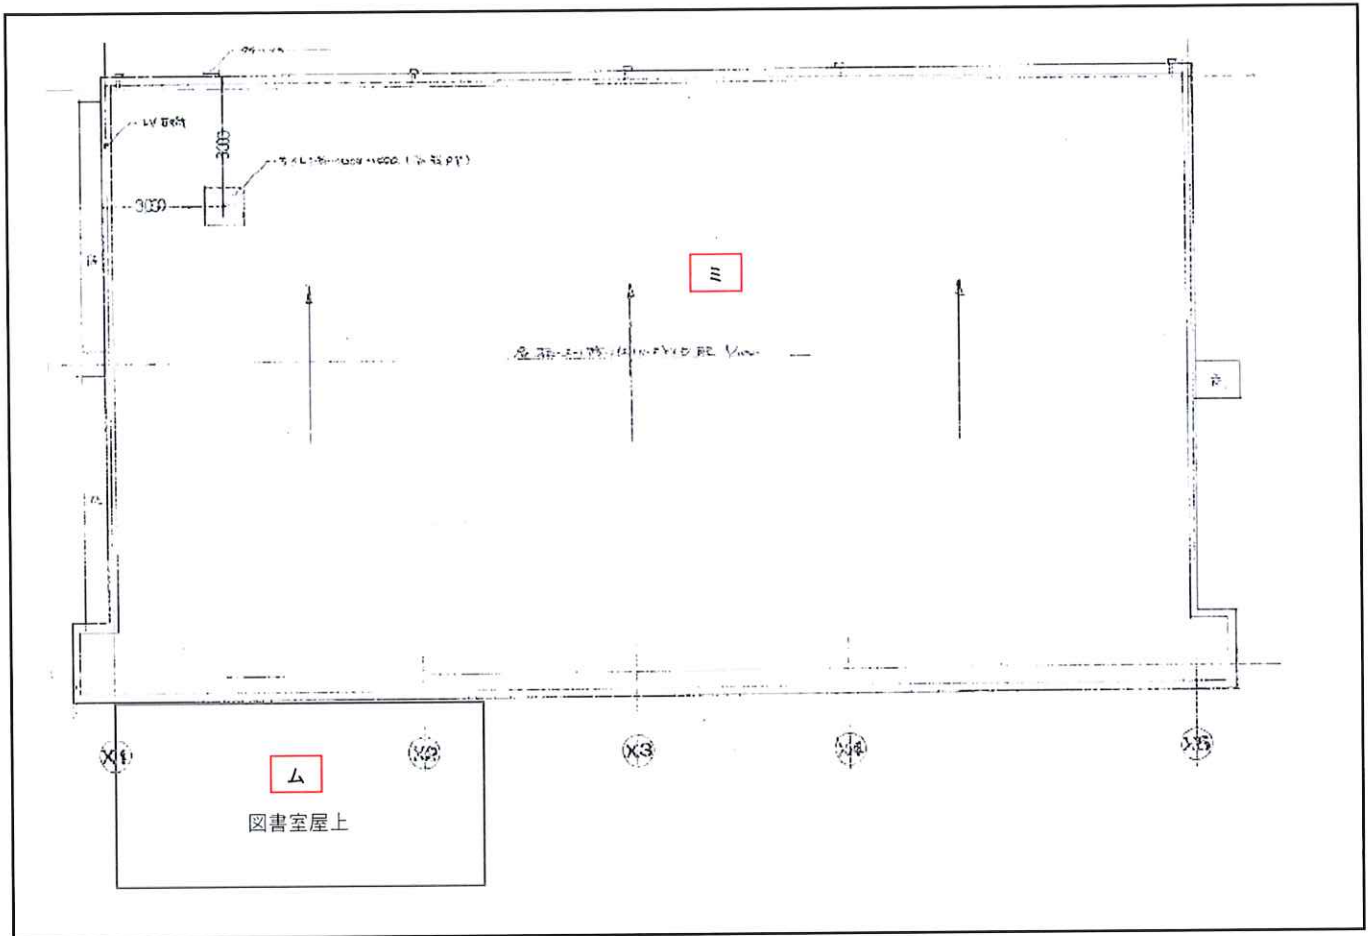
(3) 旧幸袋交流センター平面図 (屋上)
